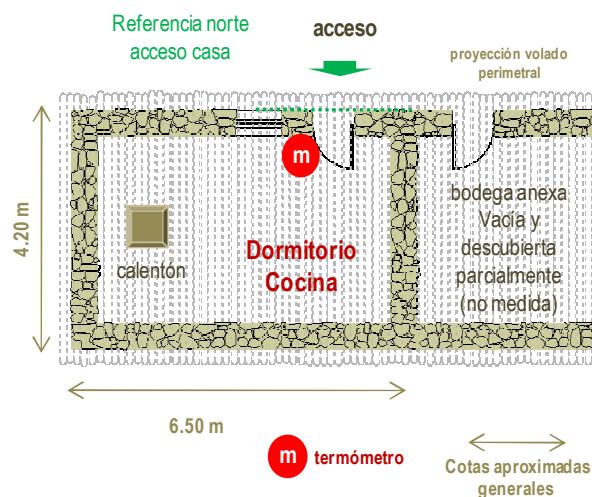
Ficha individual: Imágenes y detalles ADOBE (I y II).
